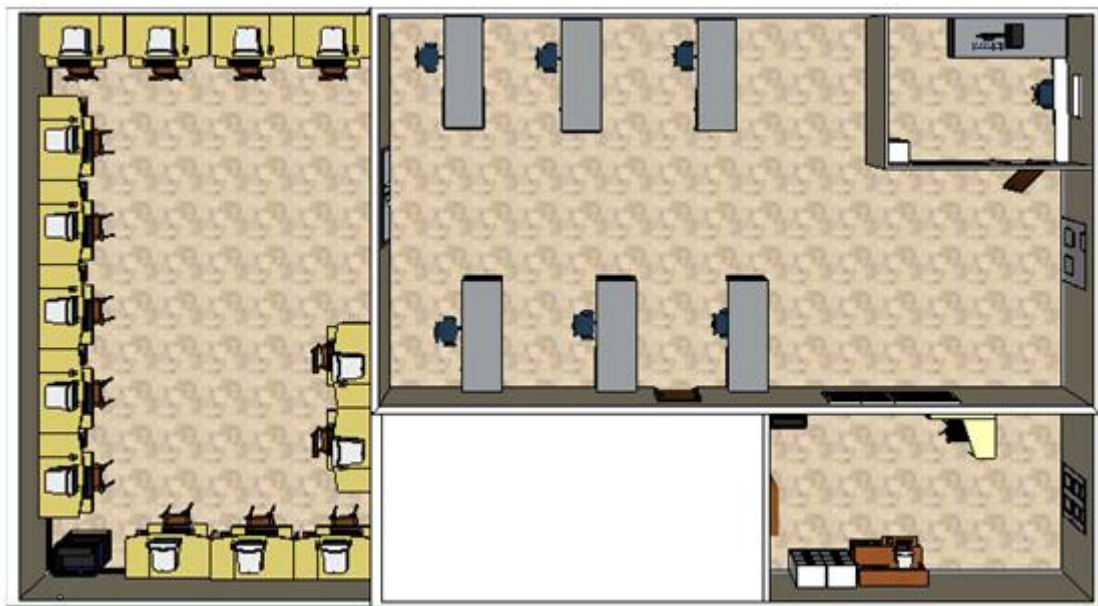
E, Vista de Planta Sala de Maestros Bachillerato Comercial y oficina de Coordinación.
